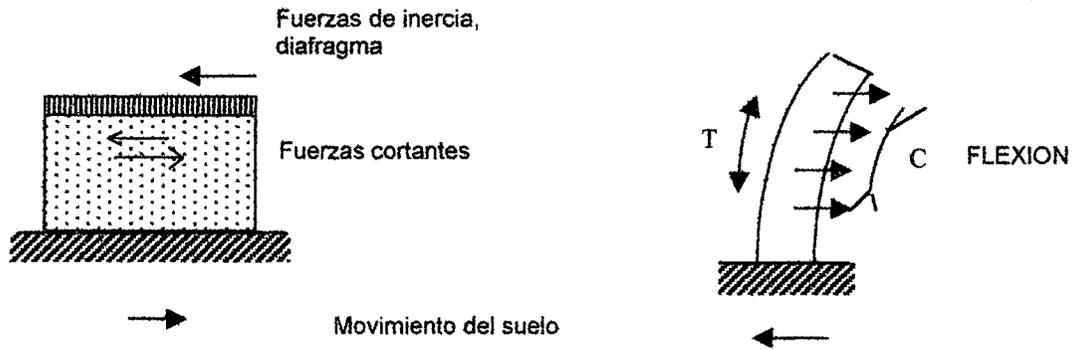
Fuerzas en muros de cortante.
